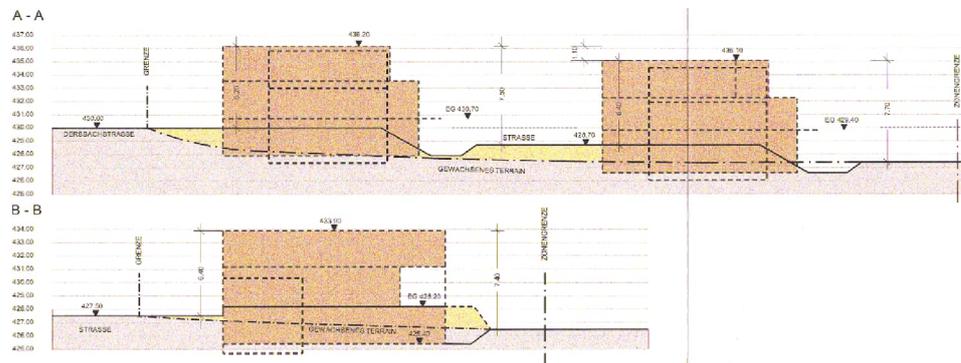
Auszug Schnitt Bebauungsplan Dersbach Langrüti, genehmigt 07.04.2010
